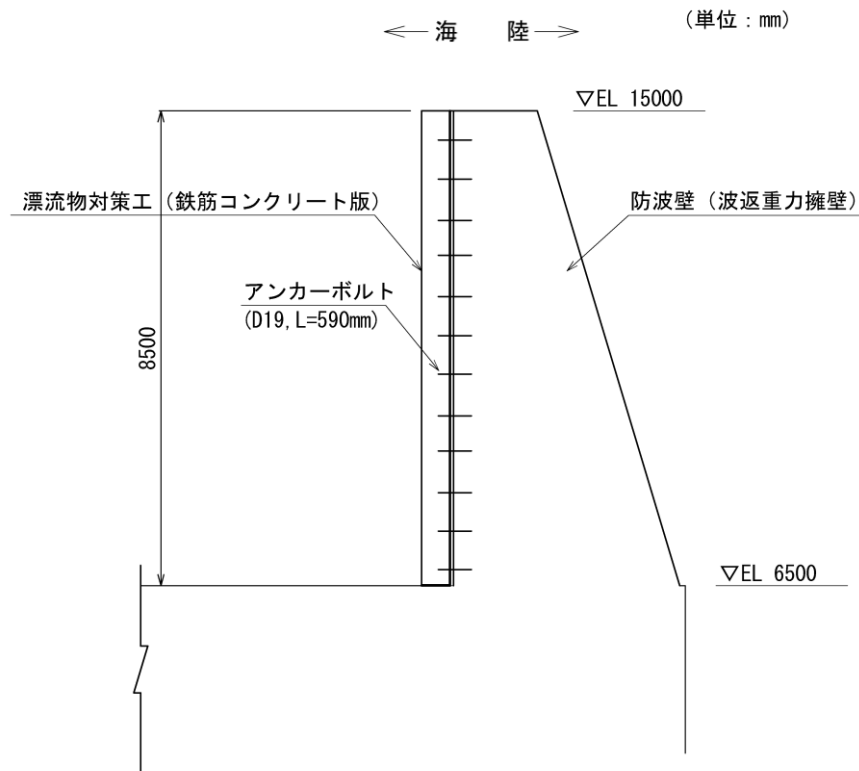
(2) 防波壁 (波返重力擁壁) 重力擁壁における漂流物対策工 (鉄筋コンクリート版) のアンカーボルト配置図 (断面図)
